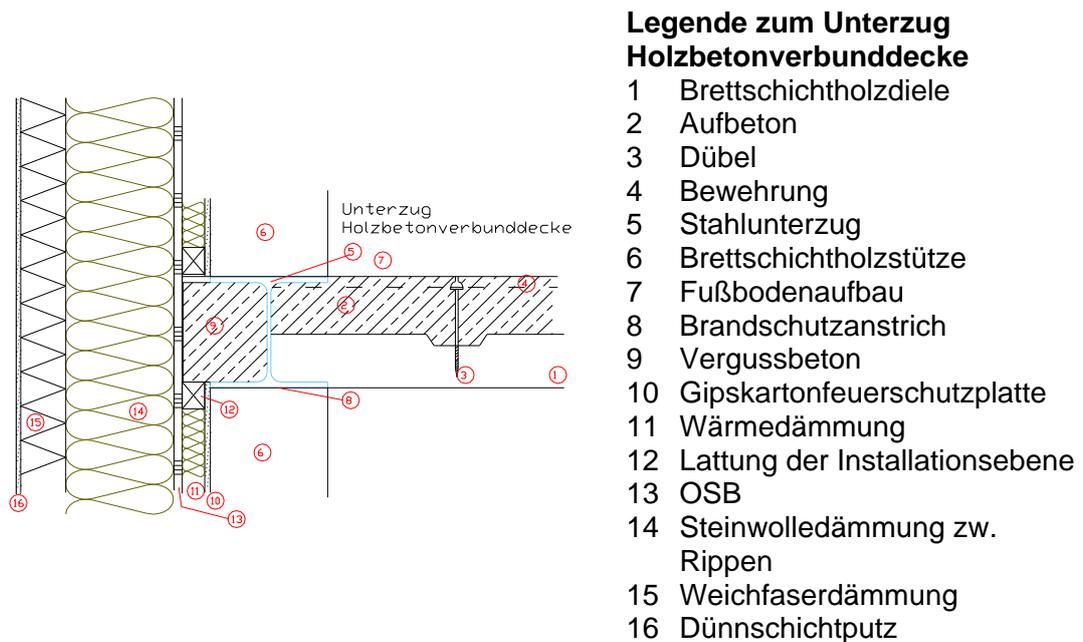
Schnitt PTS Variante Holzverbunddecke - Anschlussdetail
